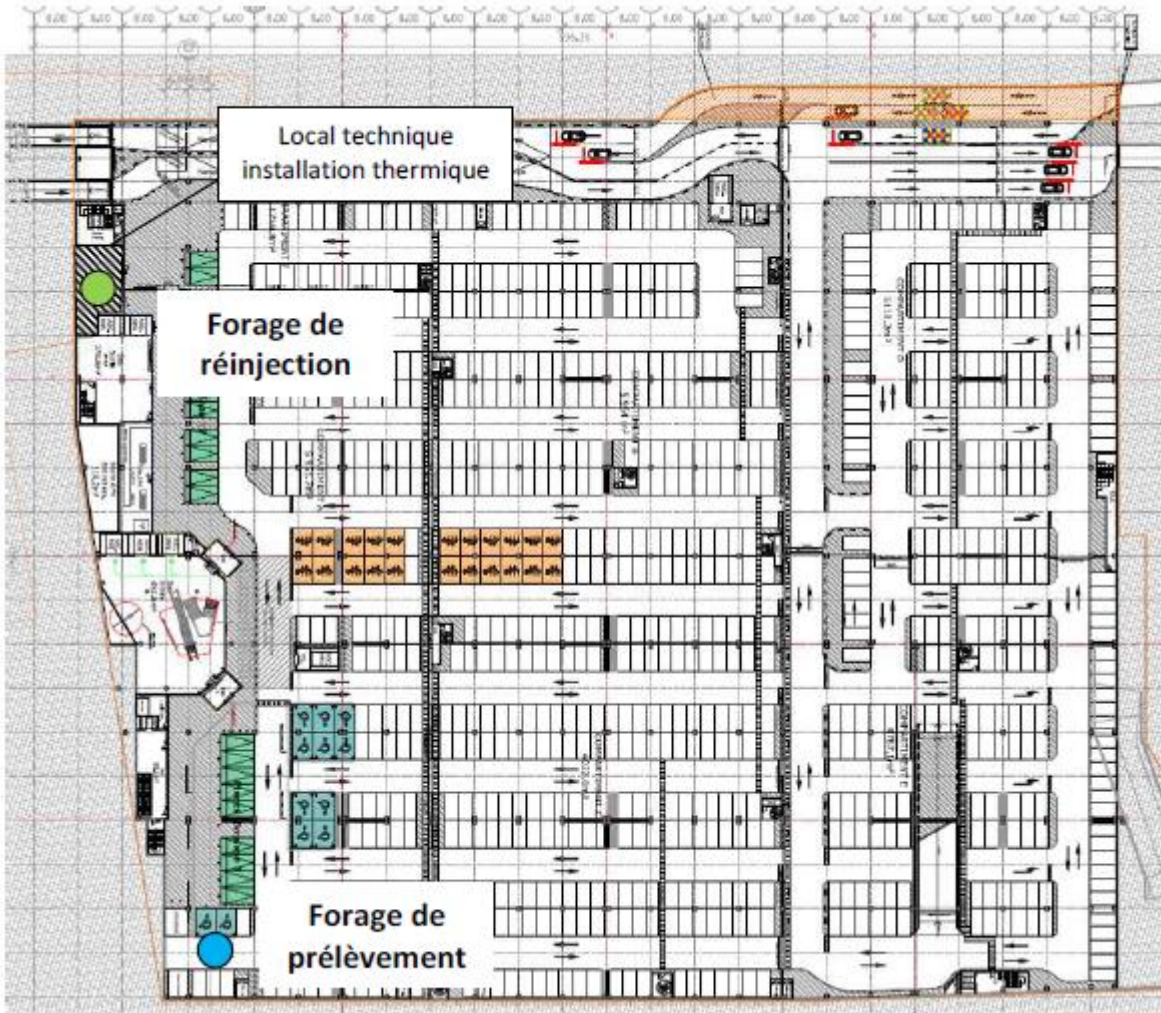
PLAN D'IMPLANTATION PREVISIONNEL DES FORAGES
